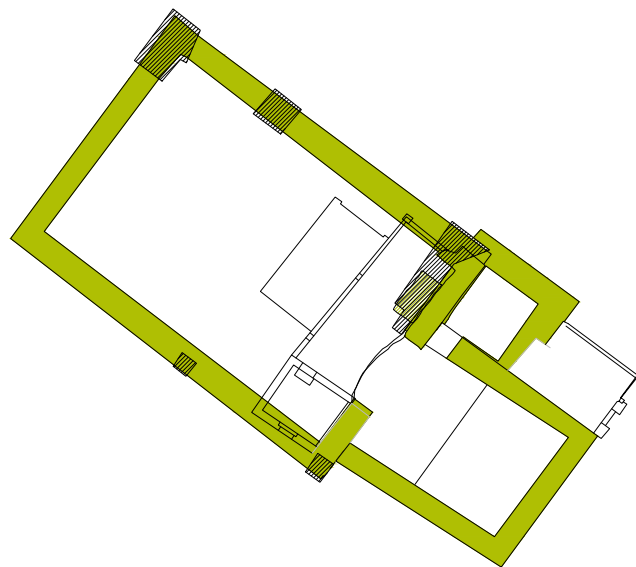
(ADB): Rekonstruierter Grundriss in Grün. Zu sehen ist links das Kapellenschiff für die Gläubigen, rechts der Chor mit angebaute Sakristei (für den Priester) und dem darauf vielleicht aufgebauten Glockenturm (siehe auch Abb. 13 –18).
